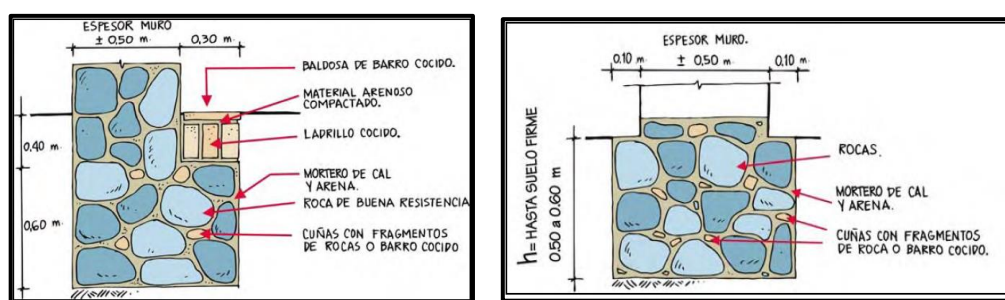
Sección transversal de un modelo de cimentación a muros ciclópeo
